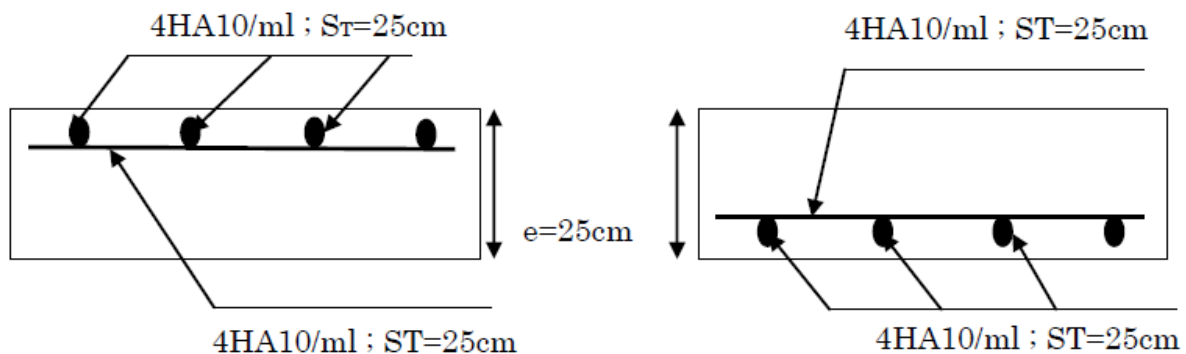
Schéma de détails de ferrailage –dalle du local machine-dalle de la cuvette
